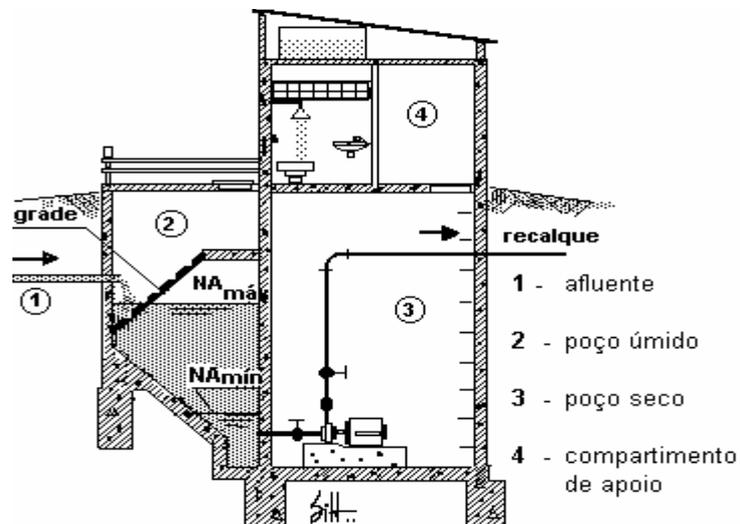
Corte esquemático de uma elevatória de esgotos
